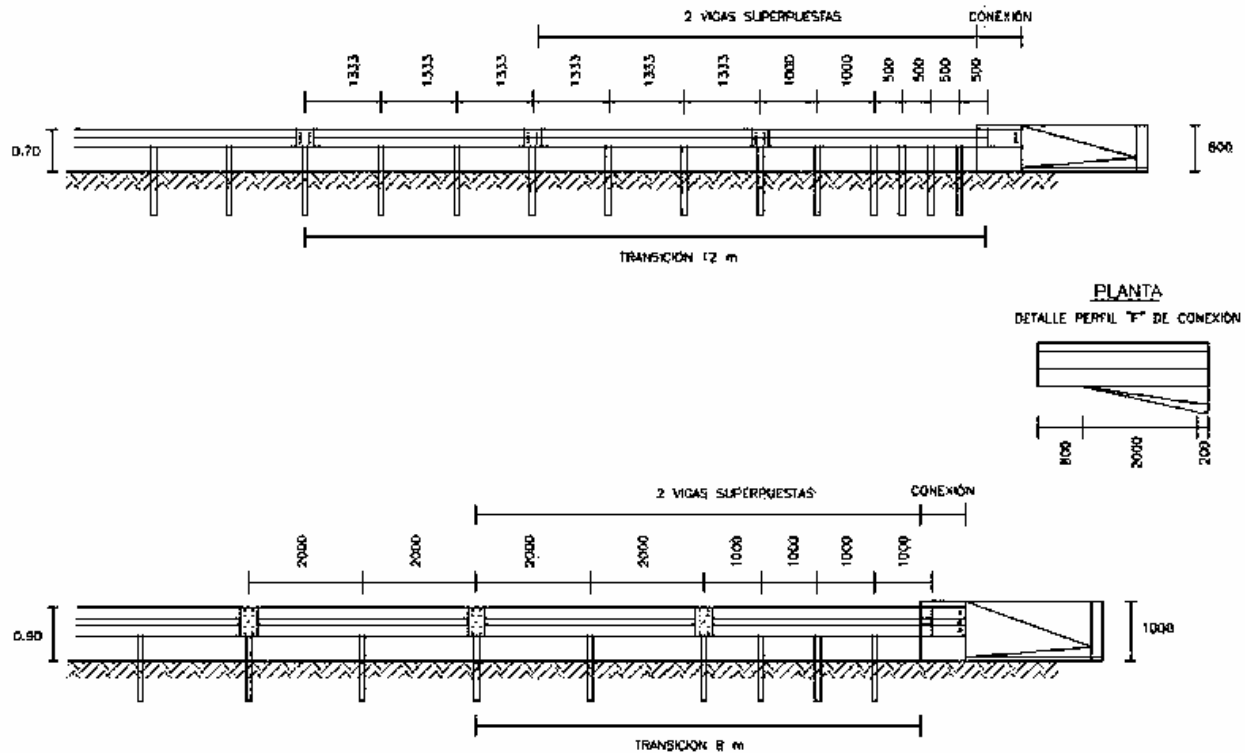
Ejemplo de transición de baranda flexible a rígida de hormigón con extremo esviado
